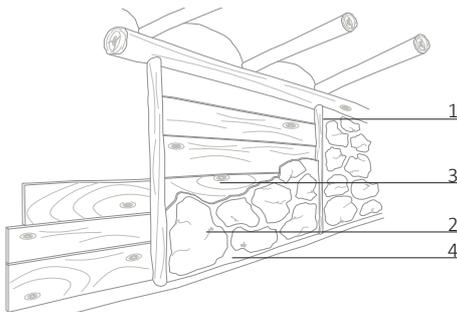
Detalle muro de lajas de piedra Fuente: propia
